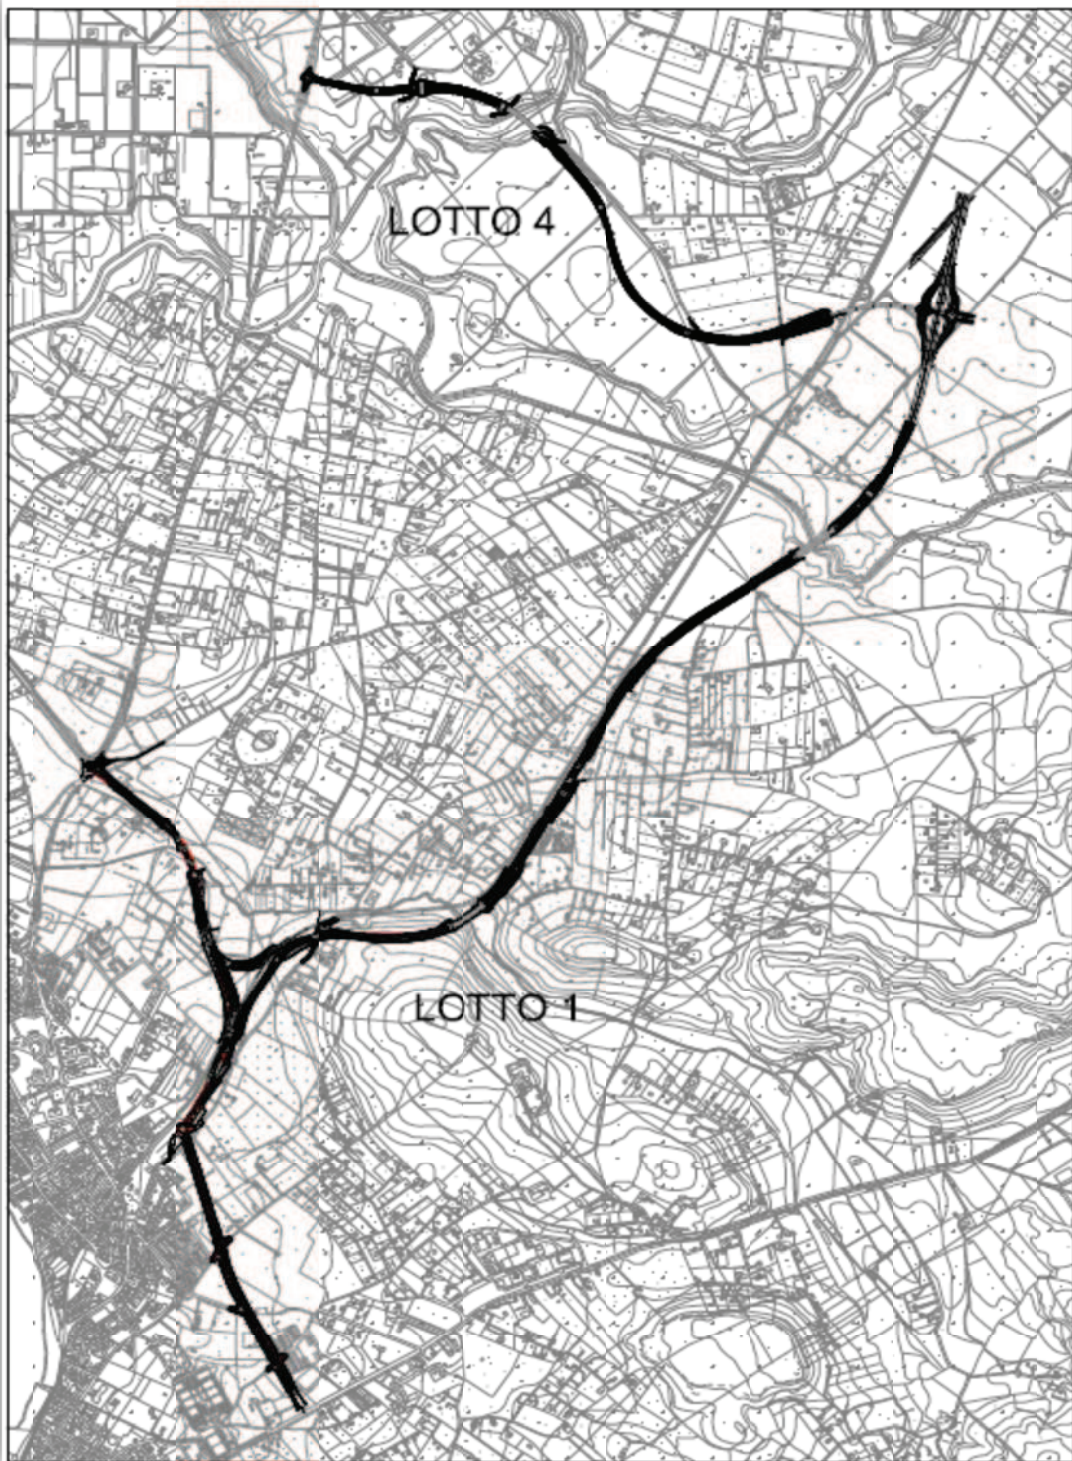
Assetto finale Lotto 1 e Lotto 4
